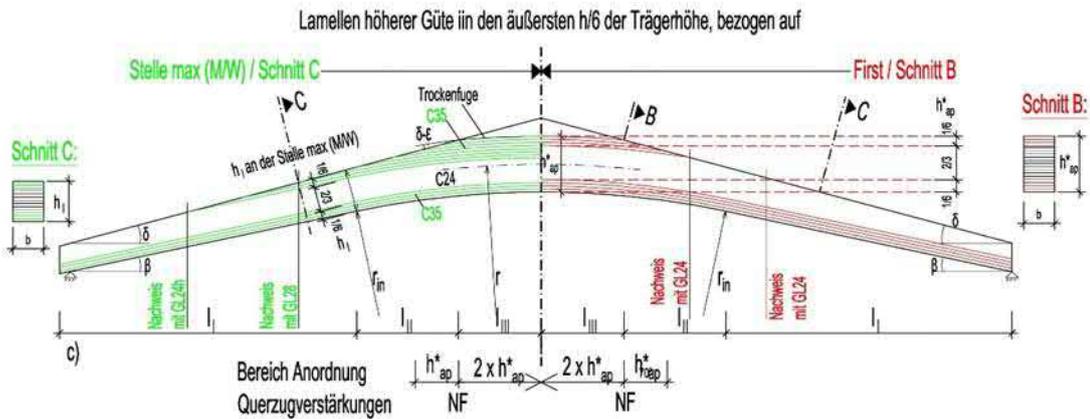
Satteldachträger mit gekrümmtem Untergurt und
